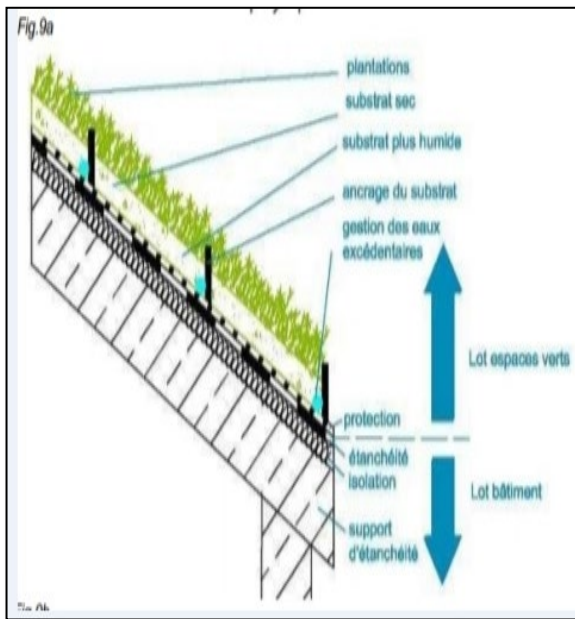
Toiture jardin extensive (PDF grand Lyon aménagement et eaux pluviale)
